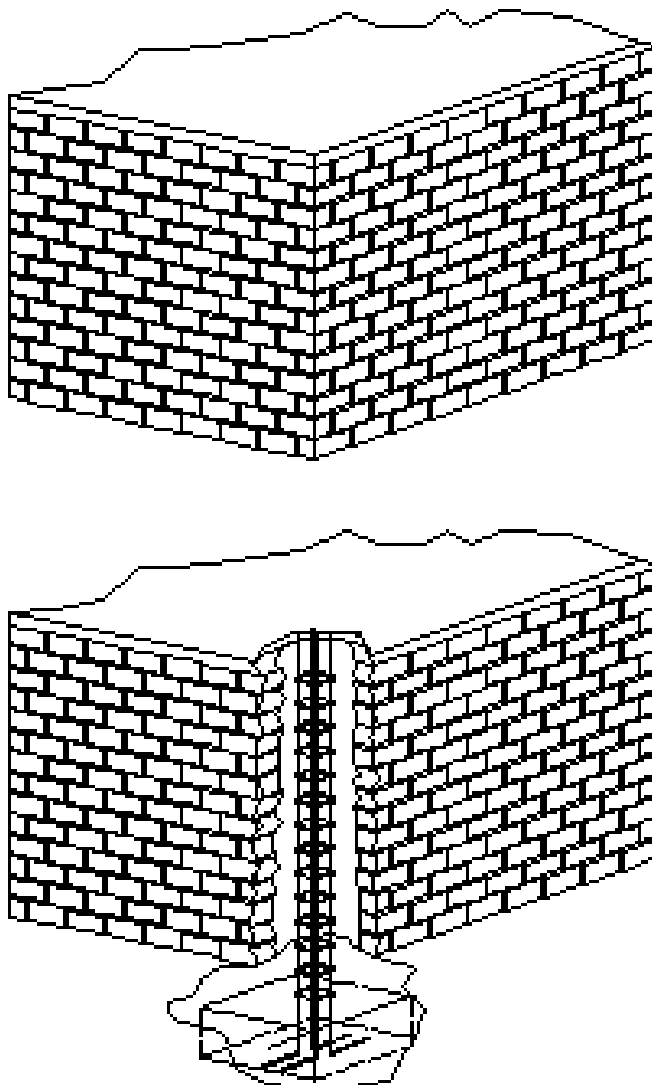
Detalle de inclusión de columnas de reforzamiento en muro sin confinamiento existente
